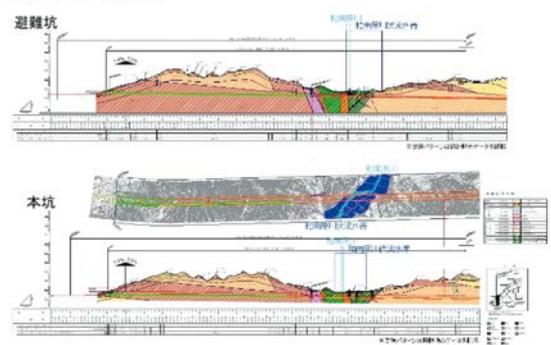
大万木トンネルの平面図、縦断面図（中国地方整備局資料）
